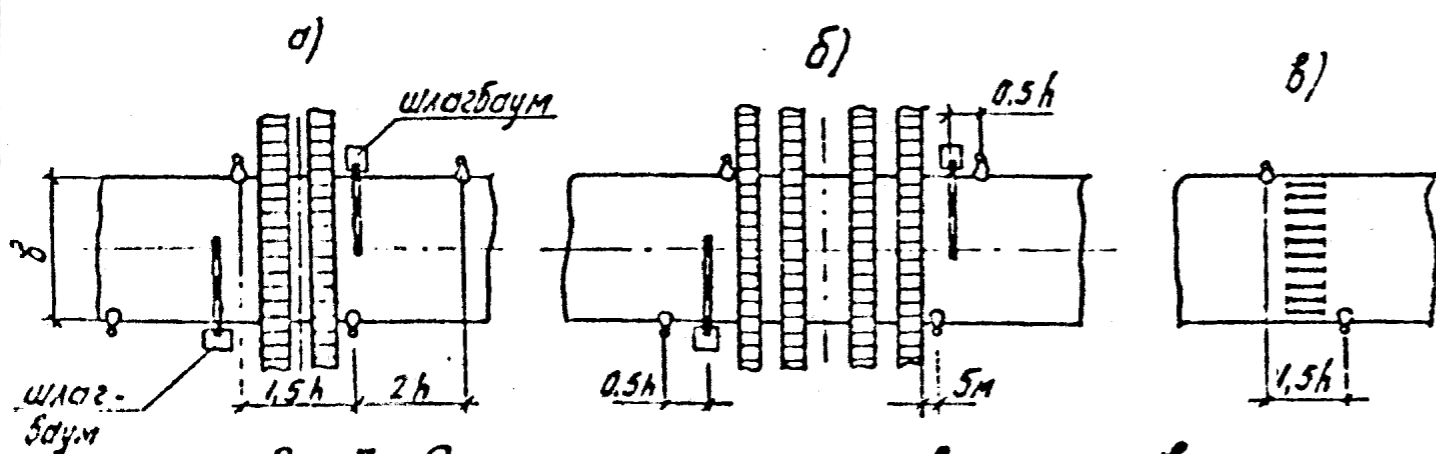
Схемы размещения светильников. а, б - на железнодорожных переездах, в - на пешеходном переходе.
